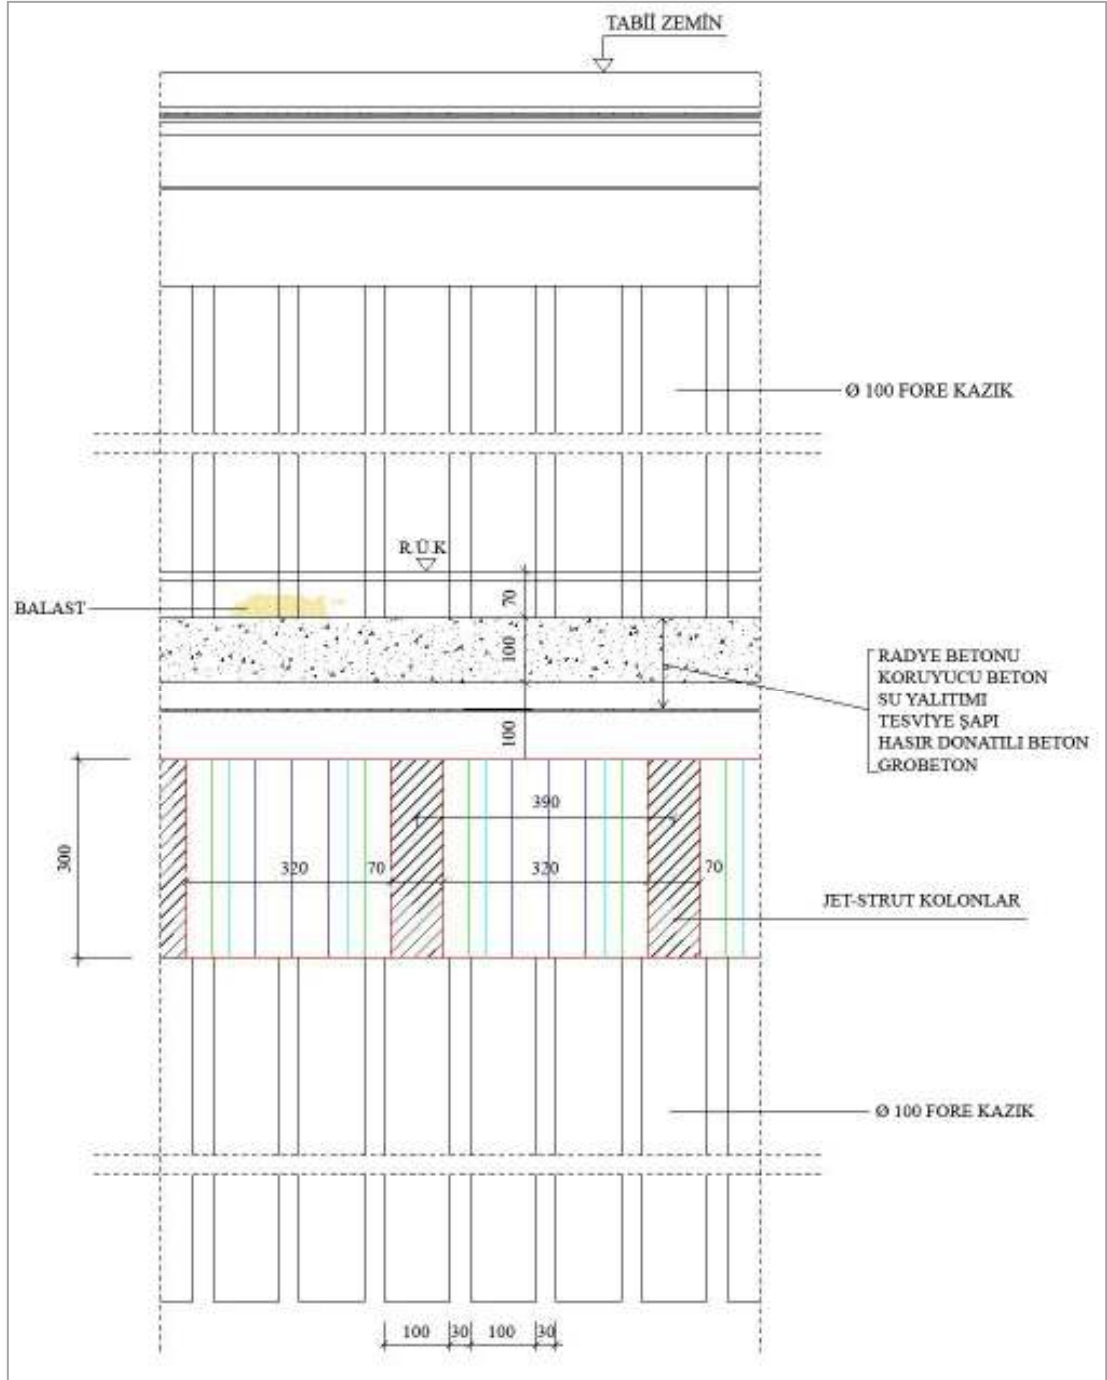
Tüneller için jet-grout kolonları planı.
